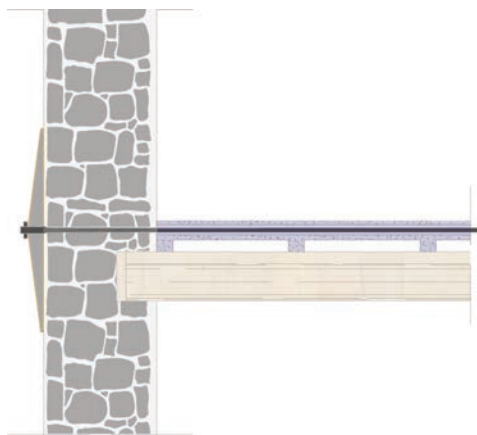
Vista in sezione di catena semplice aderente al muro trasversale a livello del solaio.
